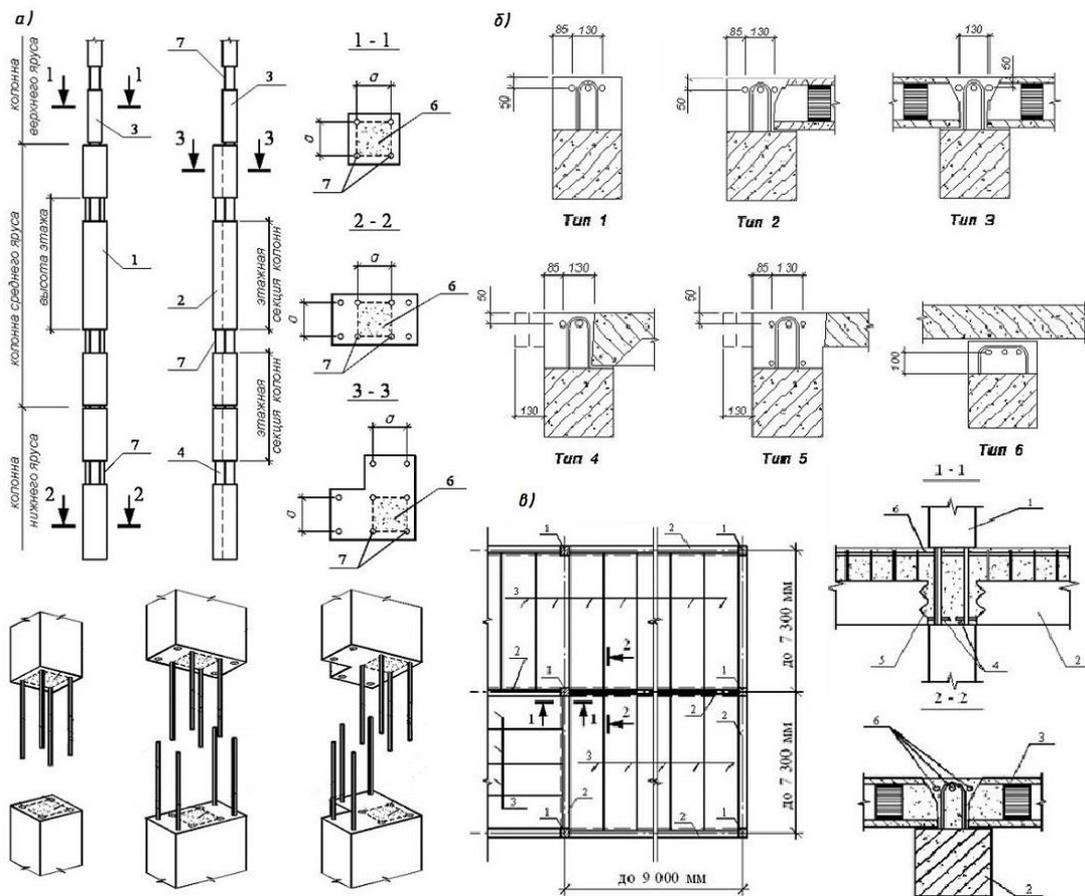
, а). На верхних гранях опорной части ригелей имеются прямоугольные штрабы для укладки монтажной опорной арматуры. Петлевые выпуски арматуры ригеля устраиваются по всей длине ригеля в два ряда. После укладки плит в проектное положение петлевые выпуски объединяют петлевыми хомутами, которые располагаются по ширине ригеля. Плиты имеют торцы со скосами со стороны примыкания к ригелю, которые увеличивают расстояние между торцами плит, что упрощает укладку арматурных стержней в верхней зоне монолитной части ригеля
